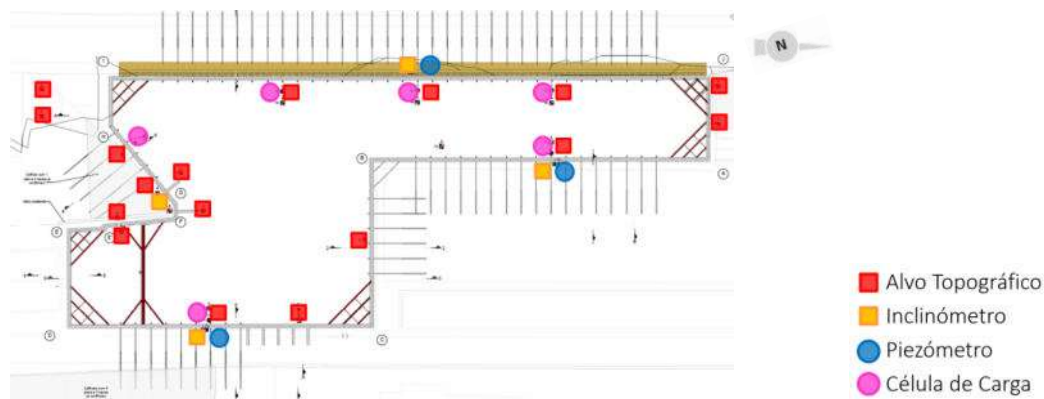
Planta com a Distribuição dos Dispositivos de Monitorização.
